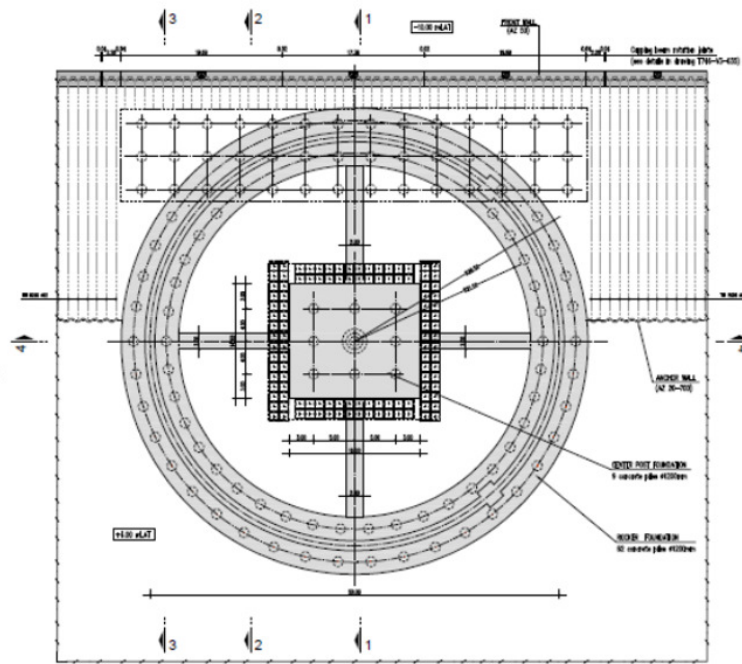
Planta geral da estrutura de fundação da HLFC.
